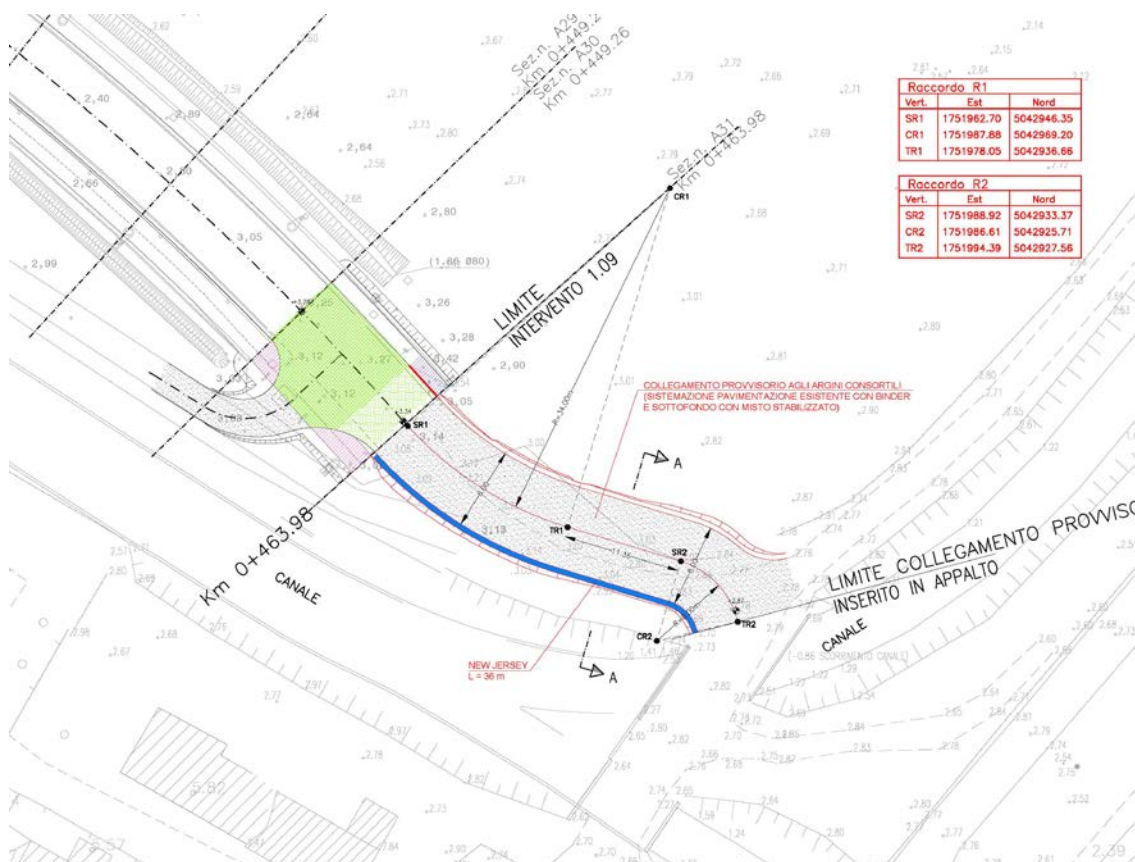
Collegamento provvisorio con gli argini consortili.
